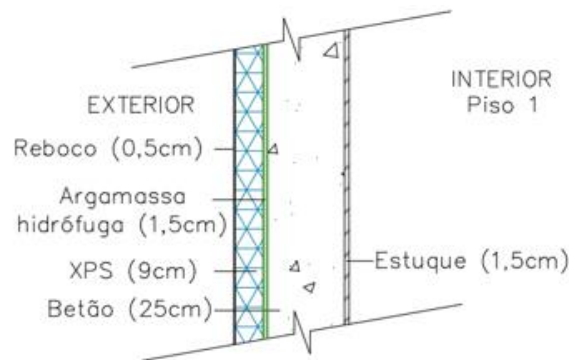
Pormenor construtivo da PPE1 devido ao pilar
